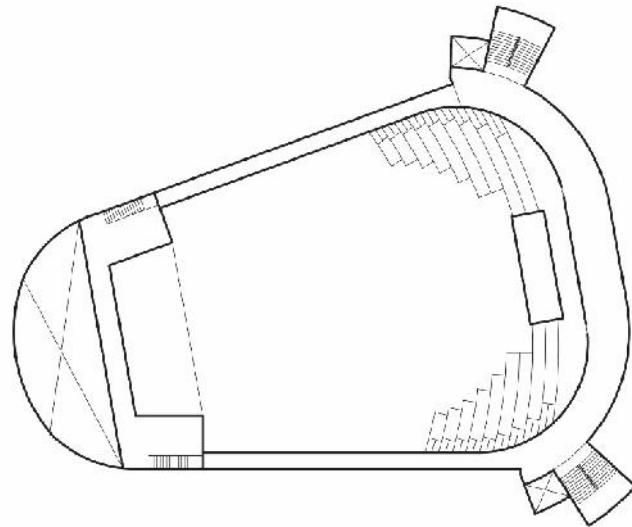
Denah Skematik *Lantai Dasar* Gedung Pertunjukan.
